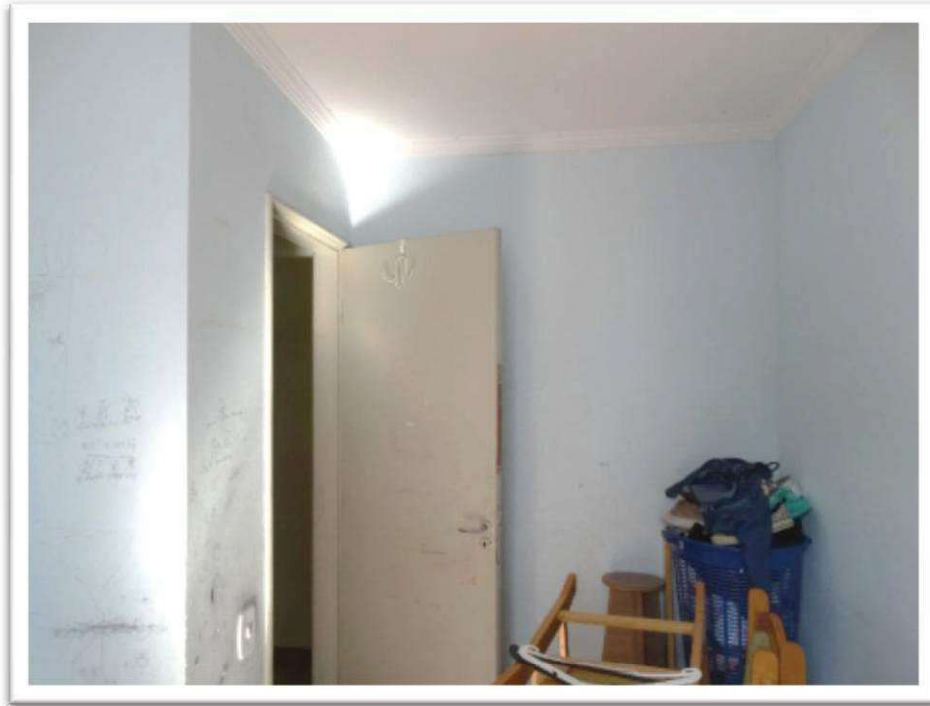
Vista parcial interna do apartamento nº 13 do Edifício Parpan – Dormitório 1.
